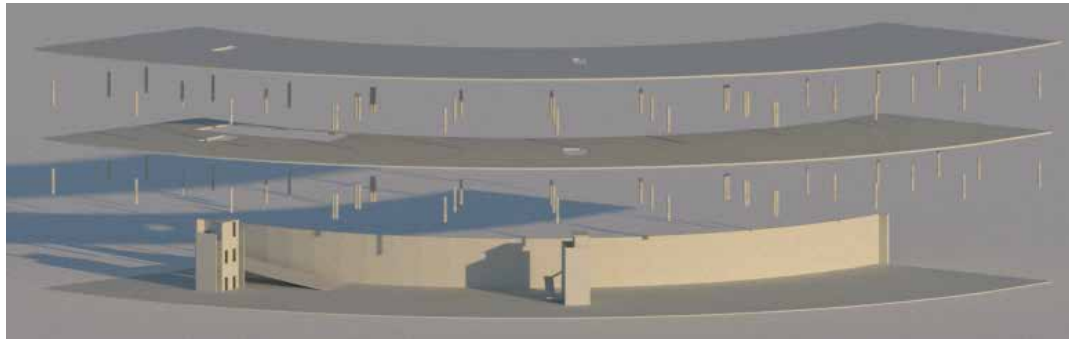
Render de la estructura del estacionamiento. La Autora (2020)
